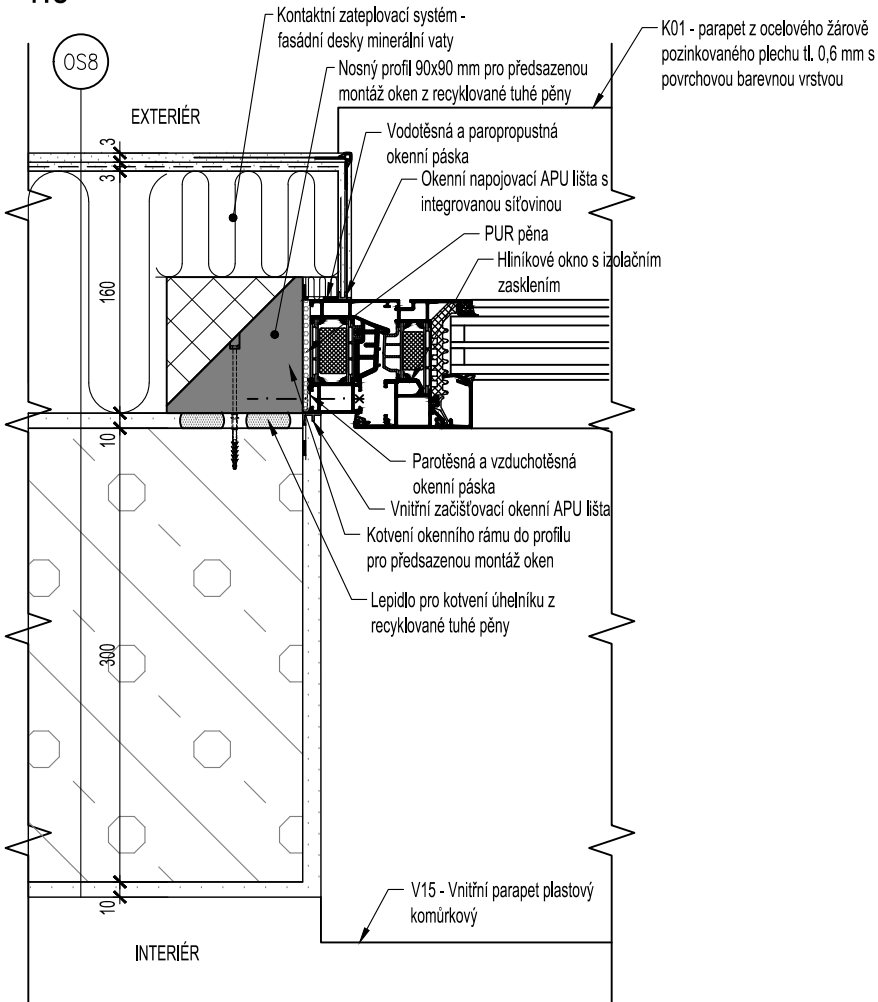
" - PŘEDSAZENÁ MONTÁŽ OKEN
